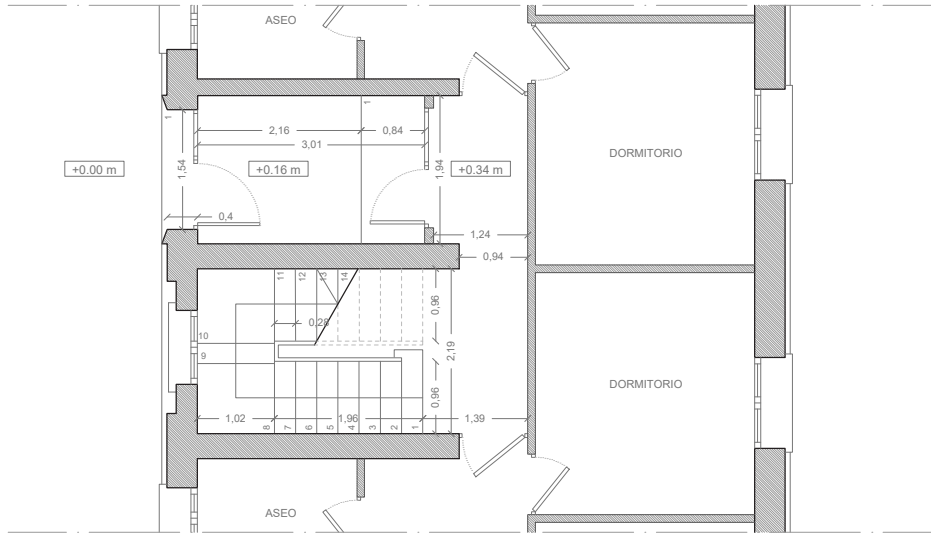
Zoom núcleo planta baja (e: 1/100).
